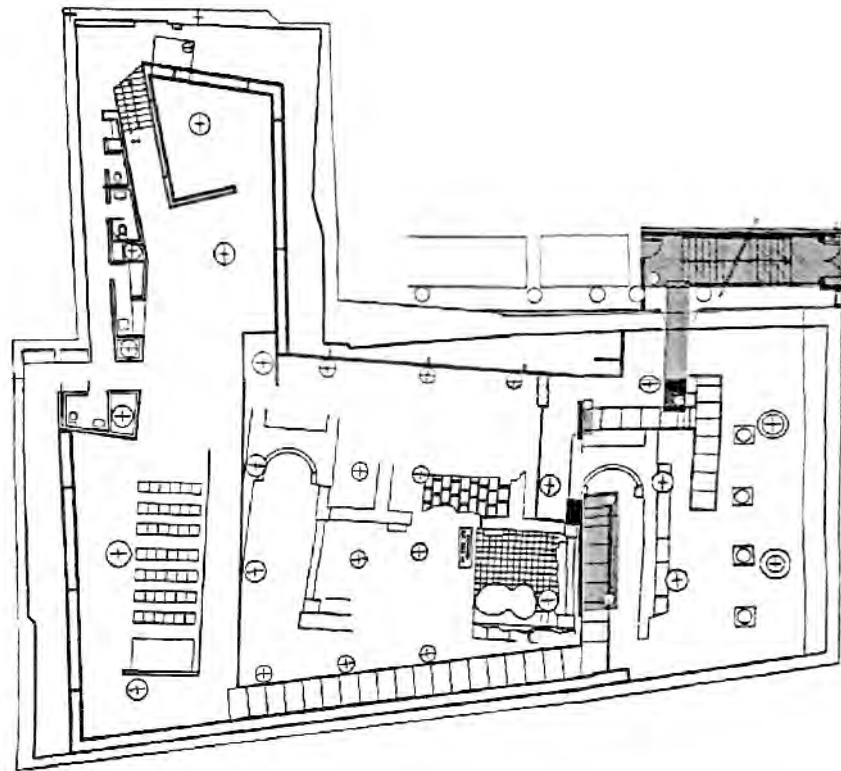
Planta del espacio arqueológico y la disposición de los pilares. (Macías y Chacón, 2005)
